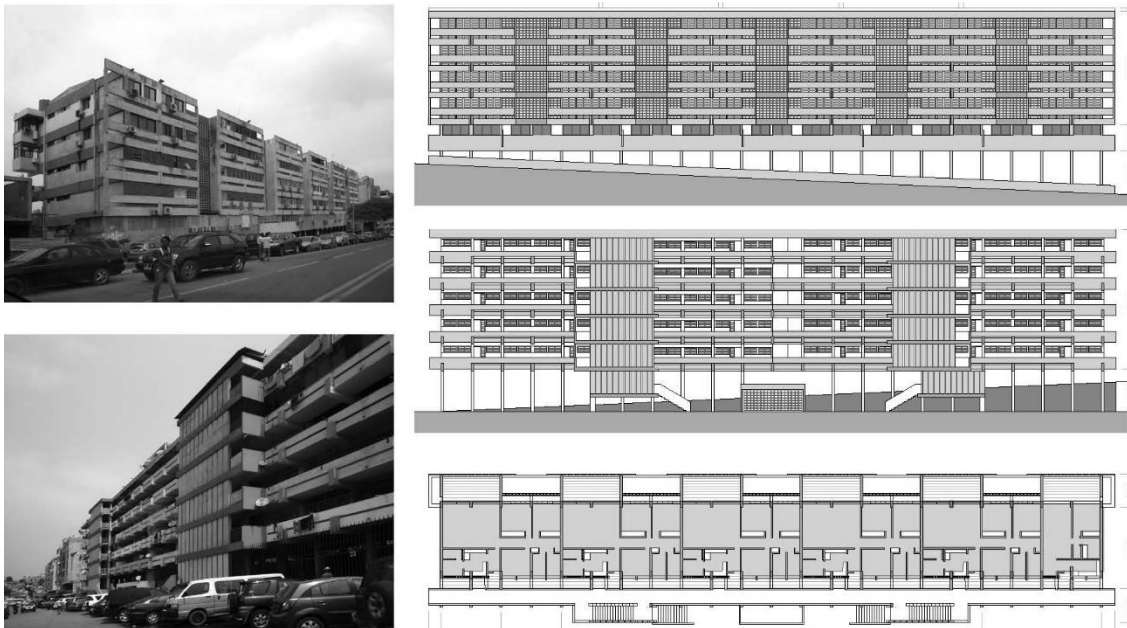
Bloco Servidores do Estado de Vieira da Costa (1965): Fotografias, Alçado Este, Alçado Oeste, Planta
